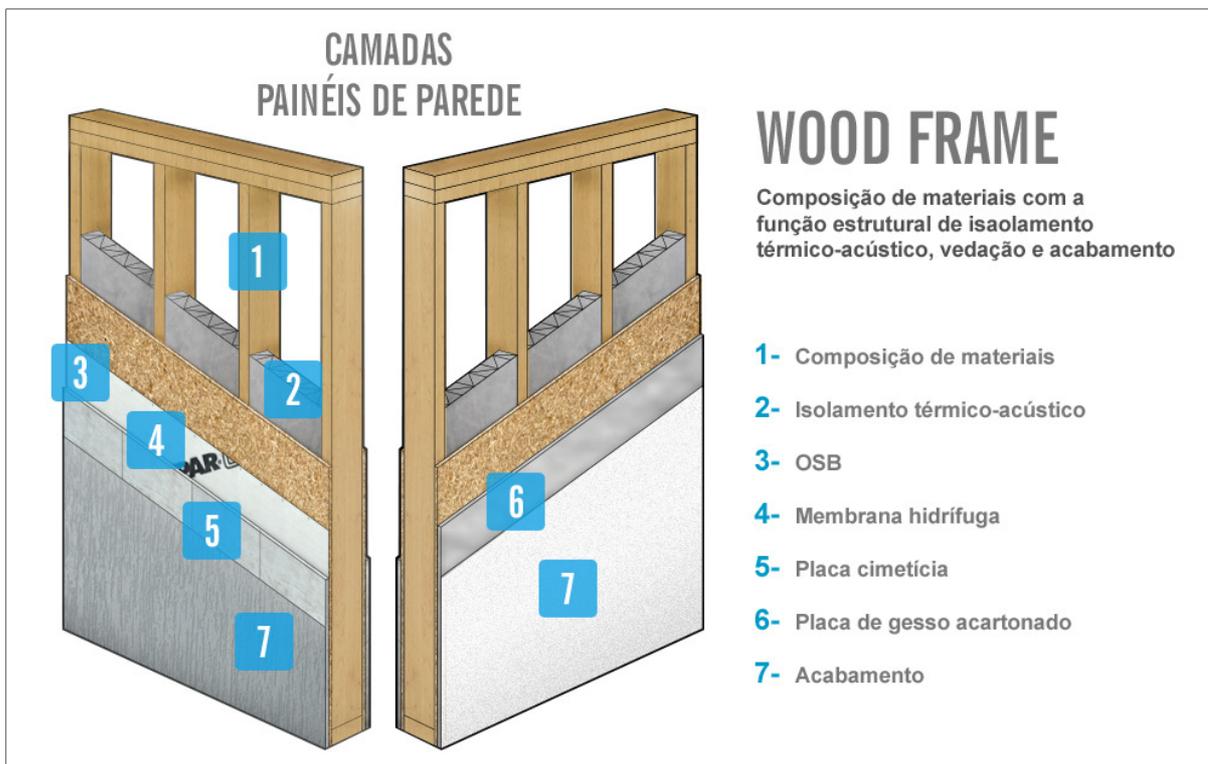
Composição da parede no sistema Wood Frame da Empresa 3
